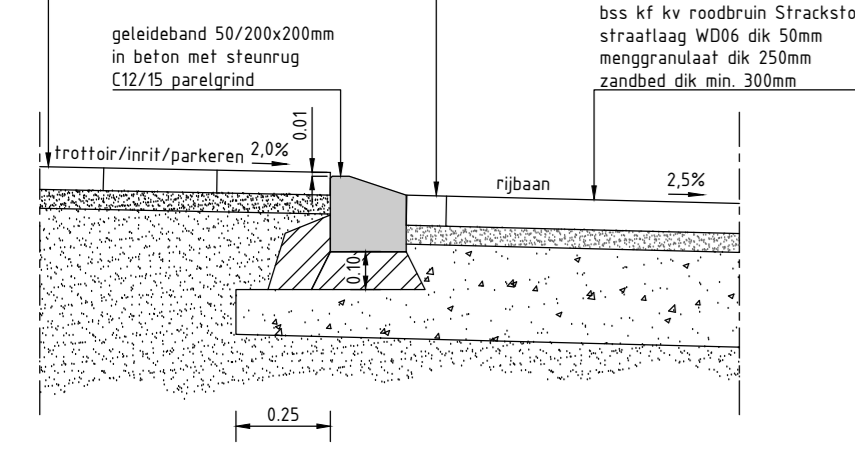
geleideband 20 langs fietsstraat met rabatstrook situatie met trottoir/inrit
